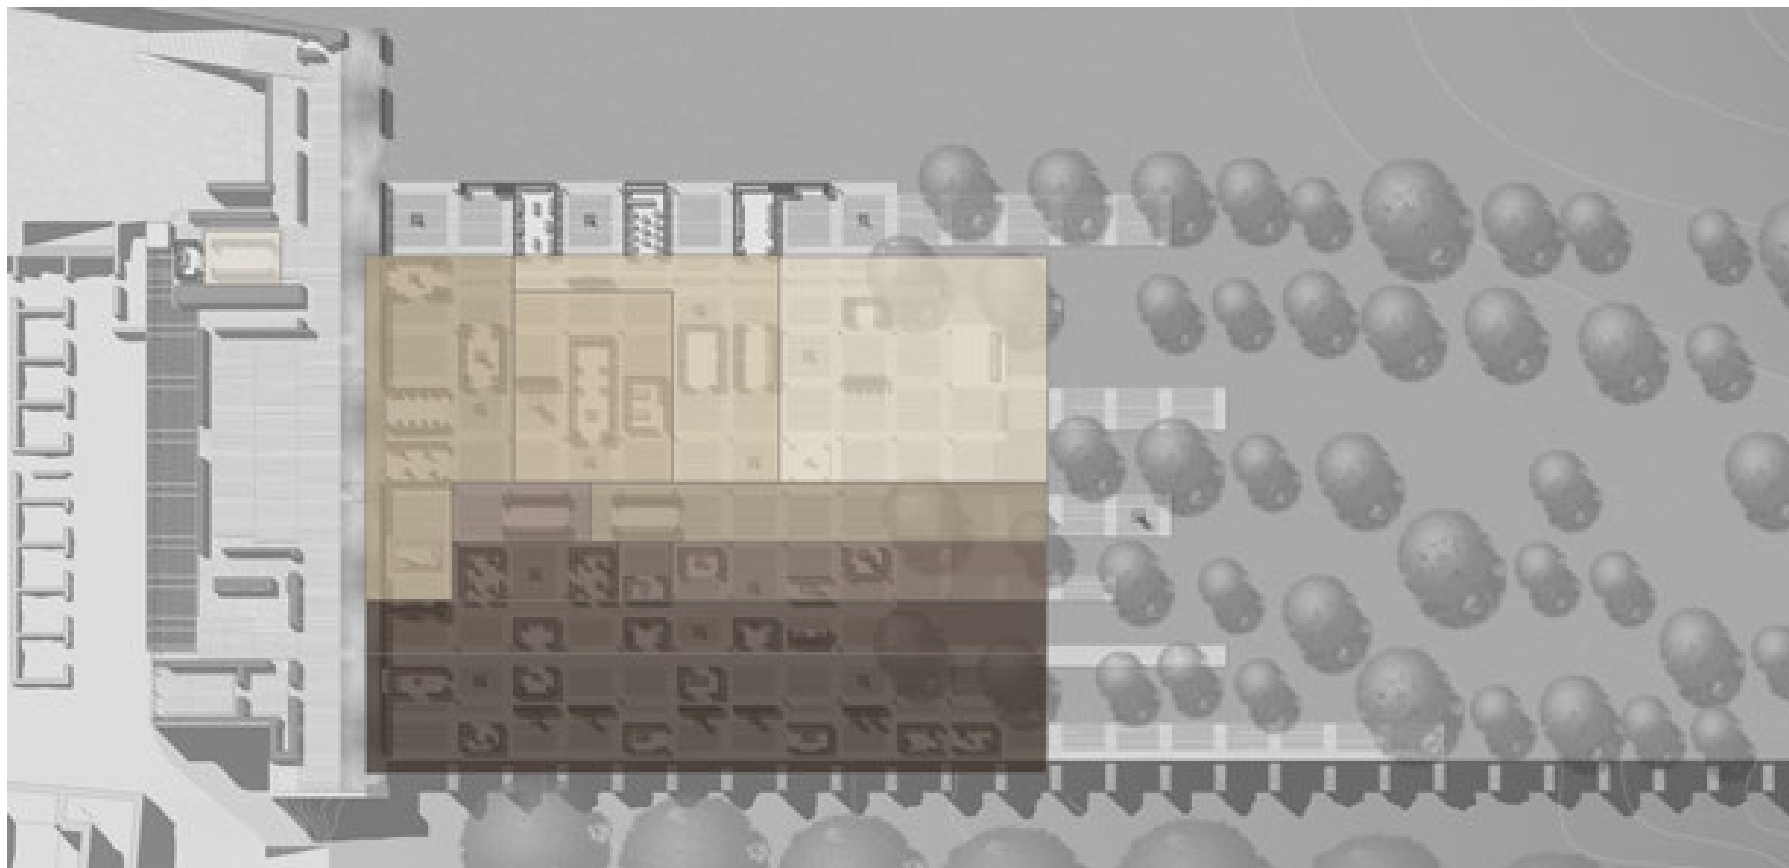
Planimetria suddivisione della collezione in base alla categoria
